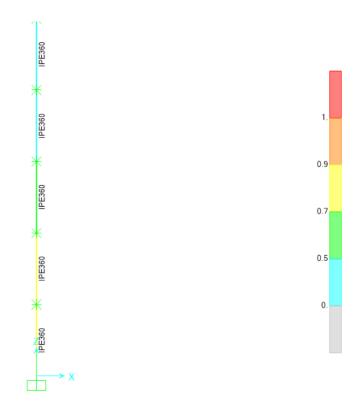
Dimensionamiento de los grupos Pilar y R.pilar. (DEAD, Viento2, Nieve).
